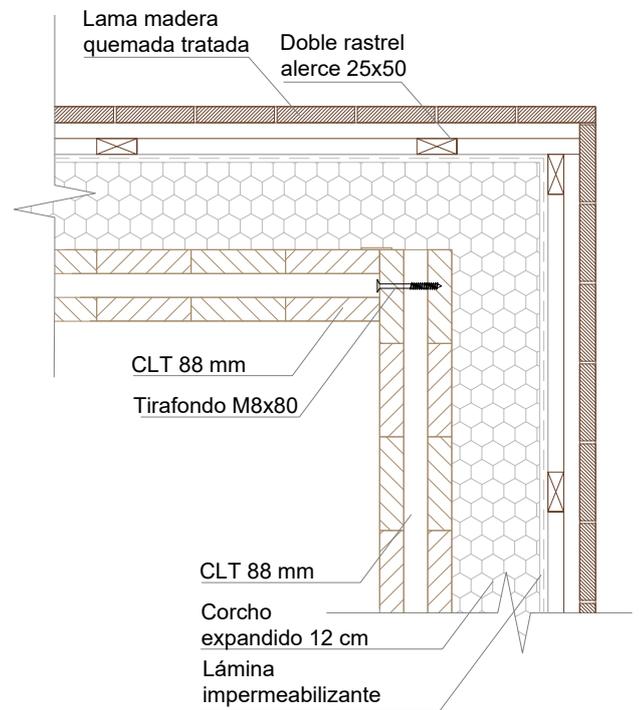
, 104 y 105: Detalles constructivos. Fuente: Elaboración propia
